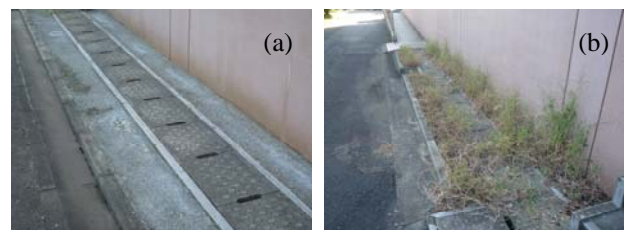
試験施工後1年が経過した(a)試験施工箇所と(b)未施工箇所との比較(2011年10月18日)
